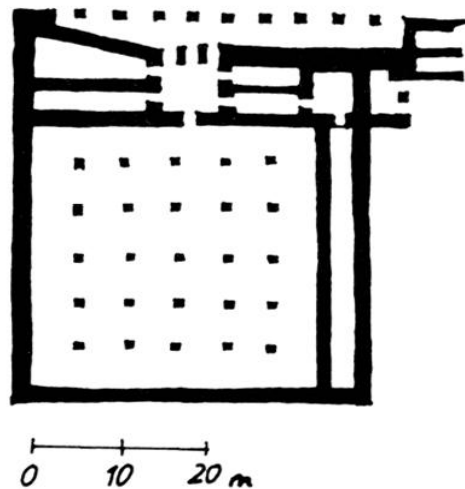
Plan d'une salle hypostyle (Büyükkale, bâtiment D, d'après Bittel, 1970, fig. 22 B).
